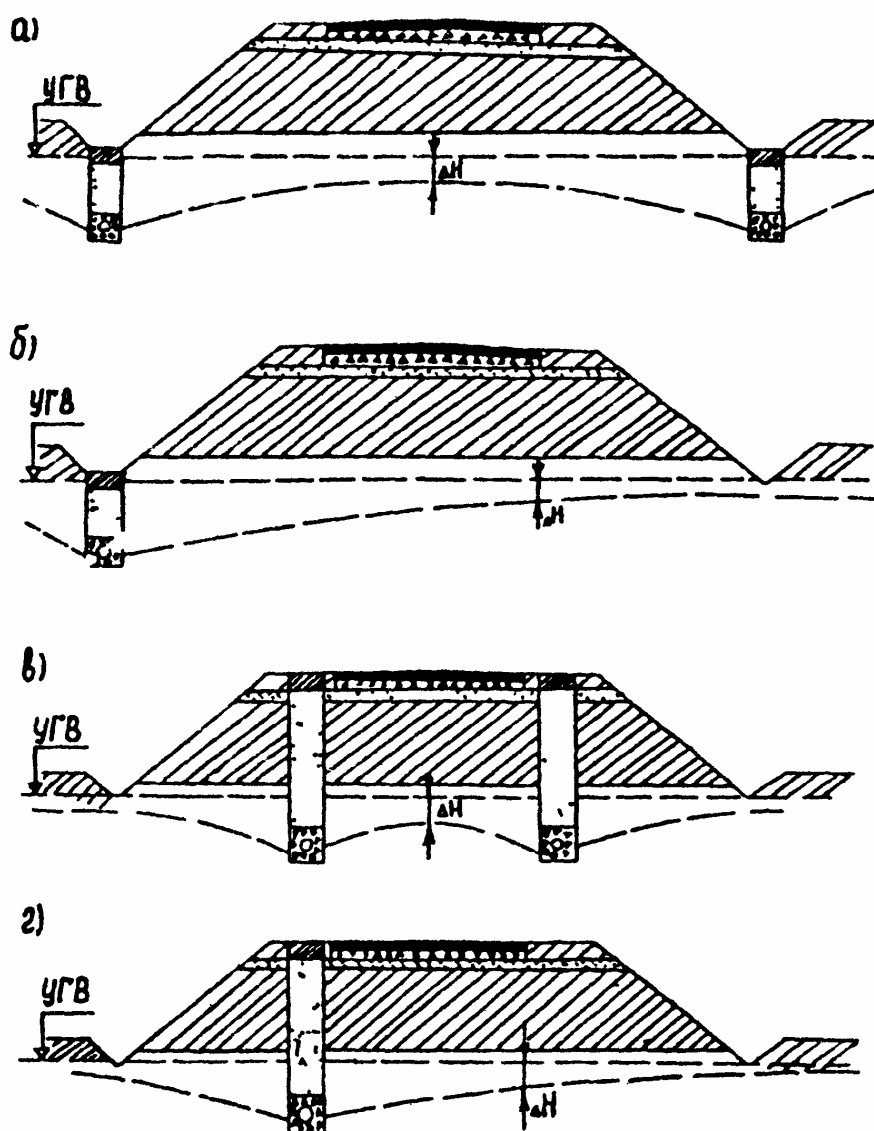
Конструкции земляного полотна с траншейным дренажом:
